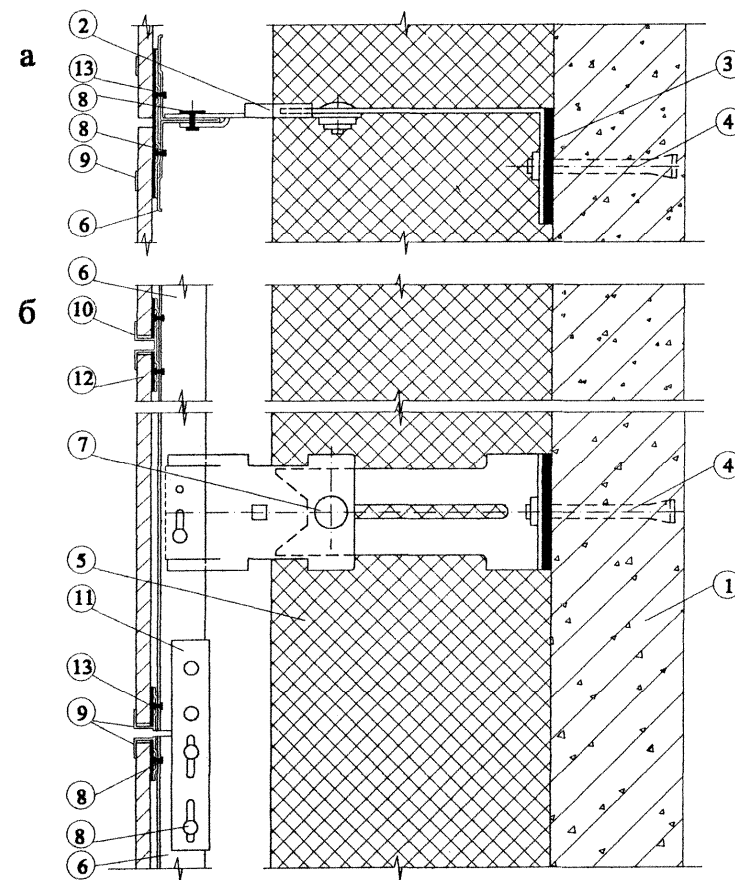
Разрез фасадной системы с облицовкой керамогранитными плитками
